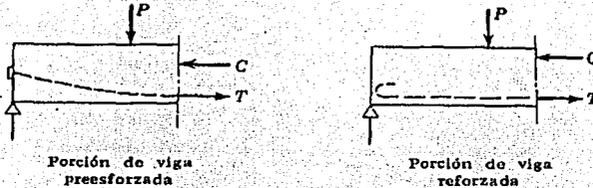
Acción del momento flexionante en una viga presforzada y una viga reforzada
